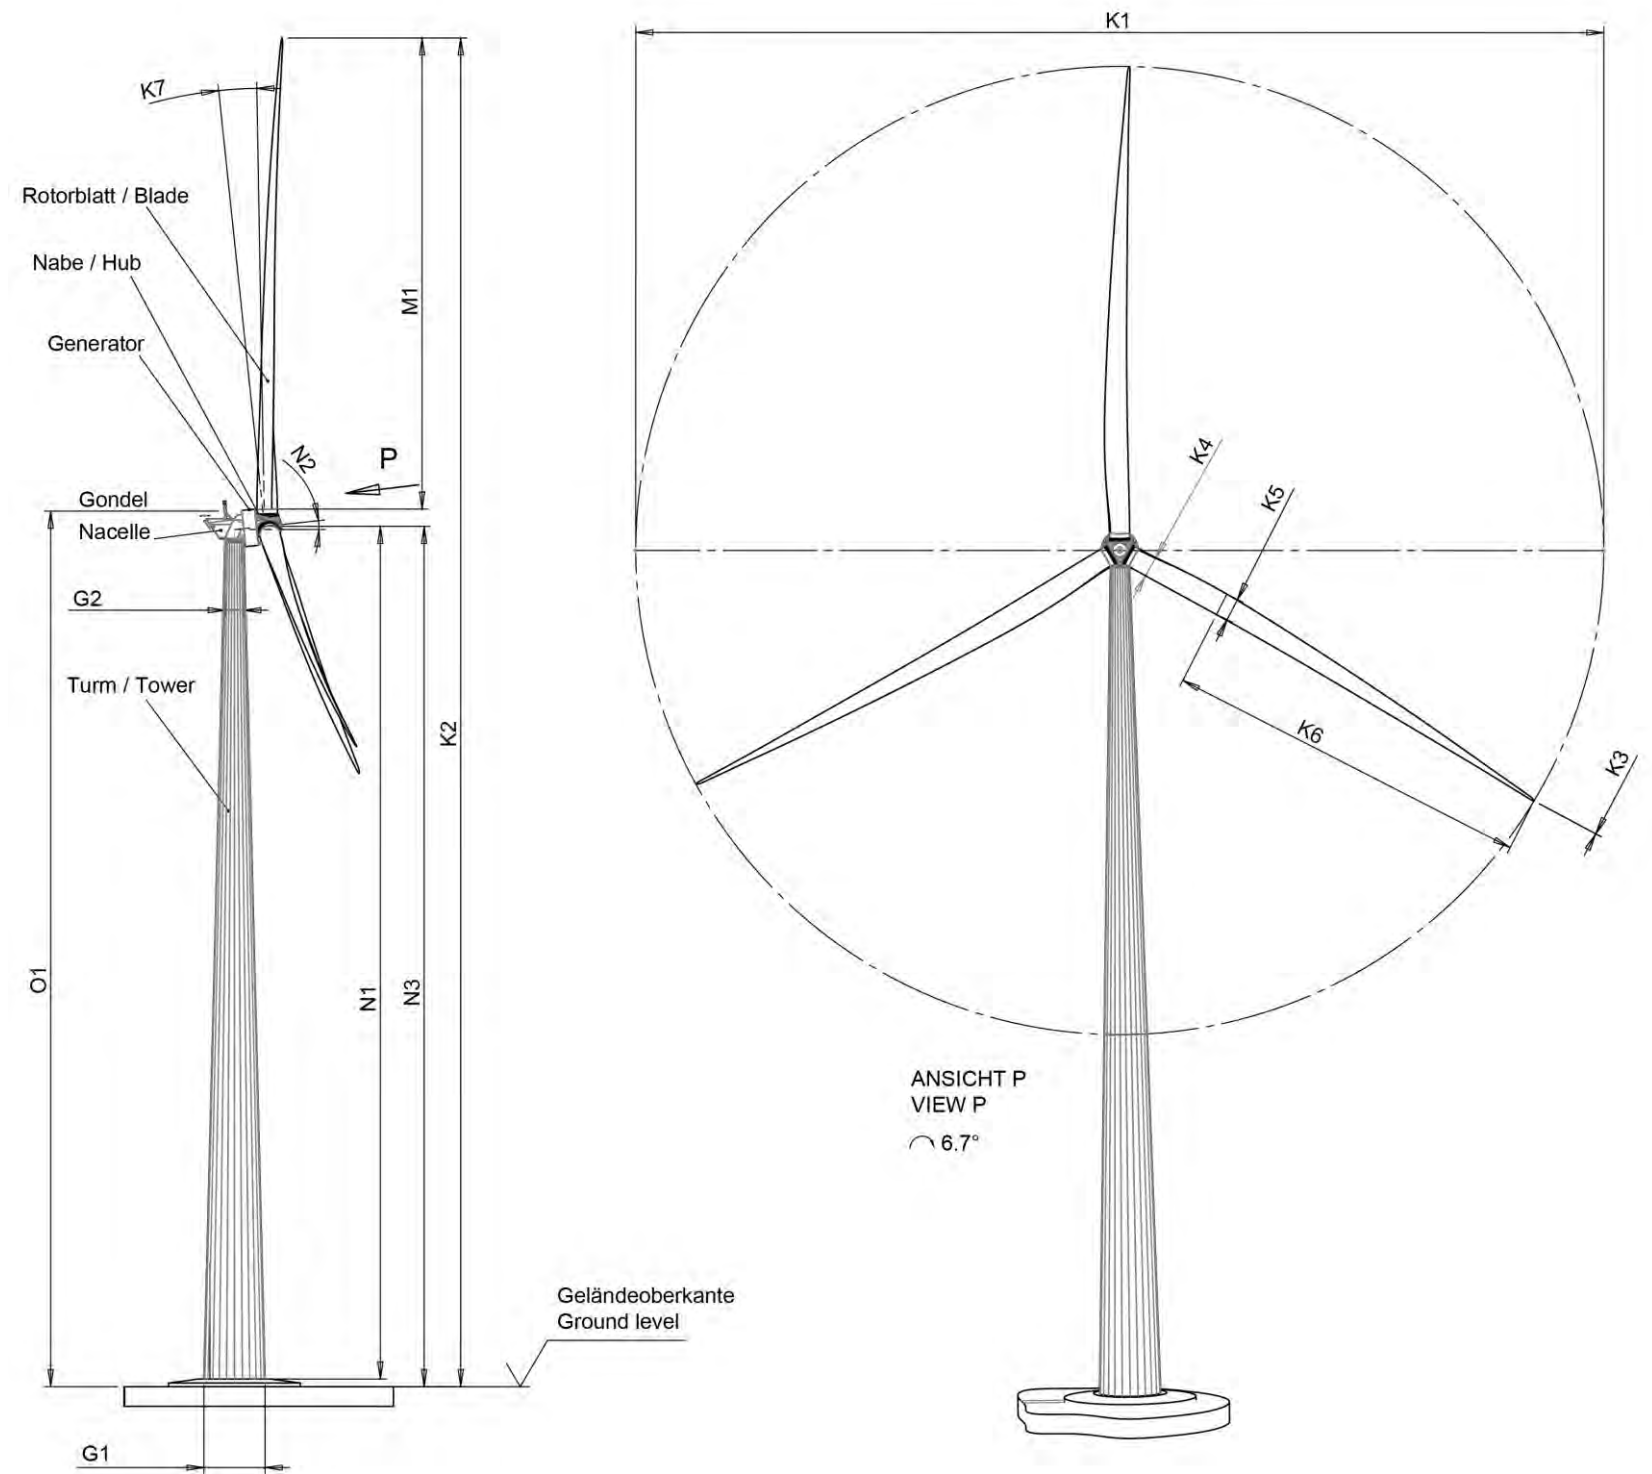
Plans de façade de l'éolienne E-160 (Source : Enercon)
